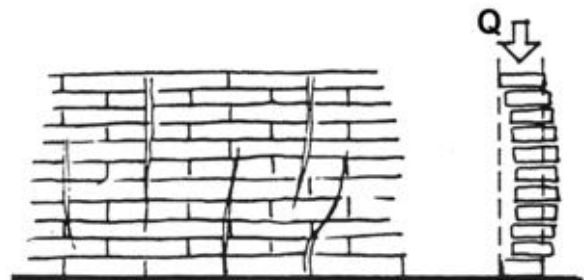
FISURACION EN FABRICA DE LADRILLO
